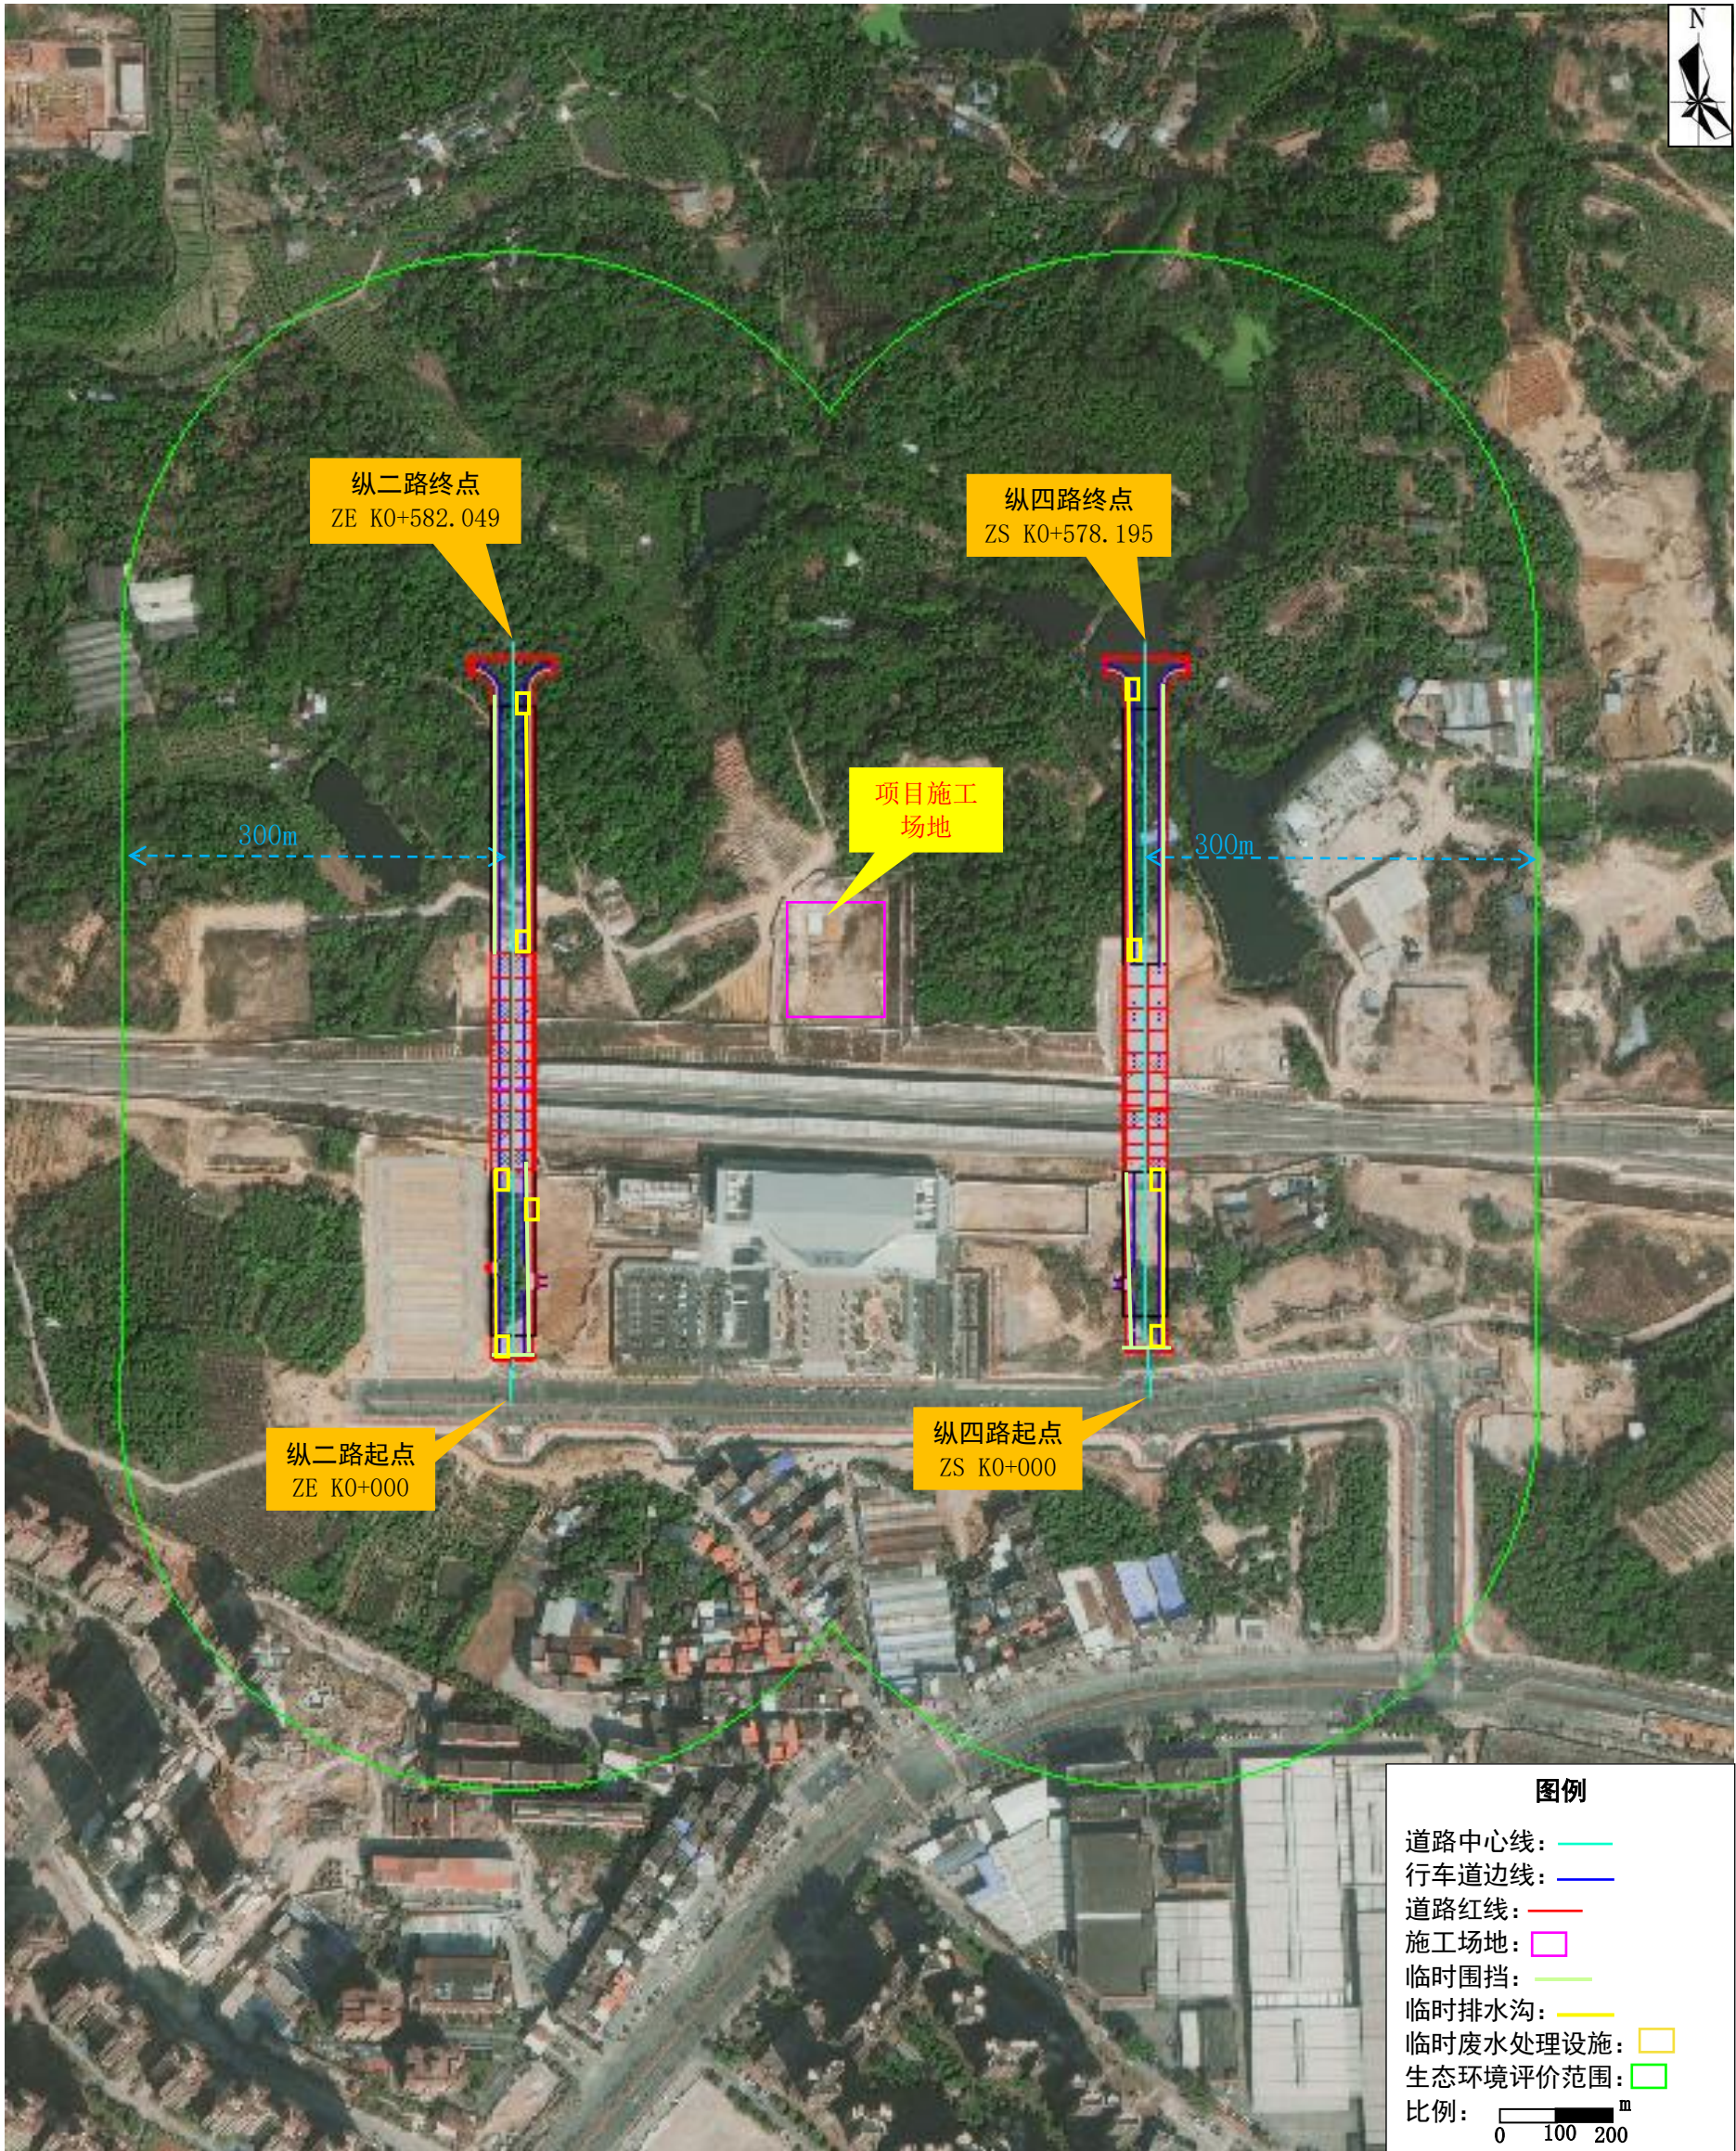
项目生态环境评价范围及施工期环保措施总平面布置图
